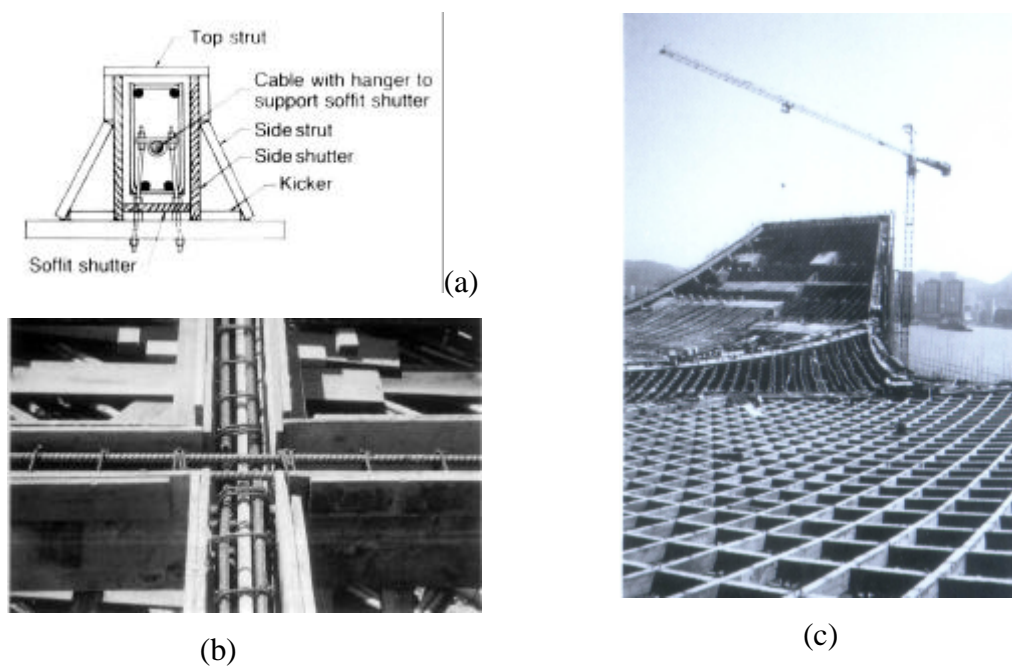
Etapa da montagem do reticulado espacial em concreto armado. fonte : BURO HAPPOLD – Consulting Engineers (Patterns 9).
